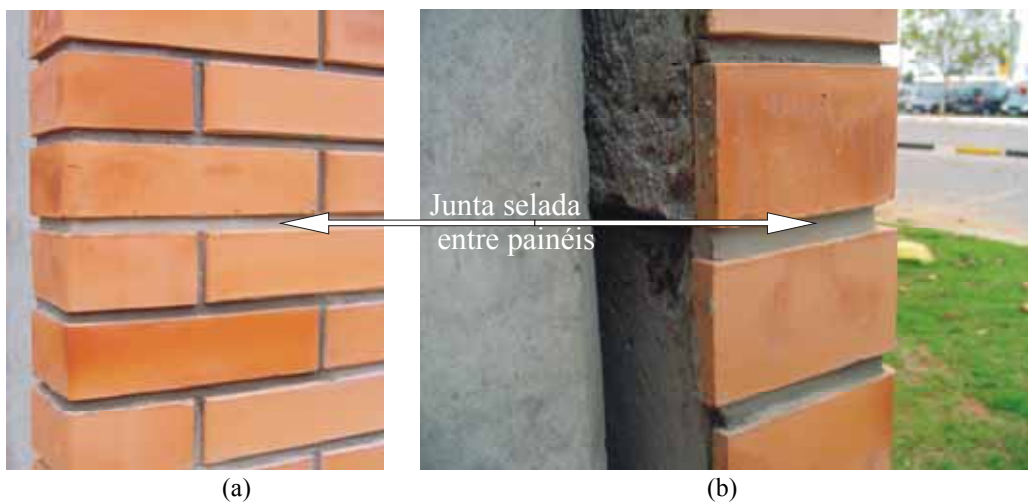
(a) vista anterior e (b) vista posterior do painel de concreto mostrando as juntas de movimentação seladas entre os painéis e as juntas de argamassa entre as plaquetas cerâmicas.
